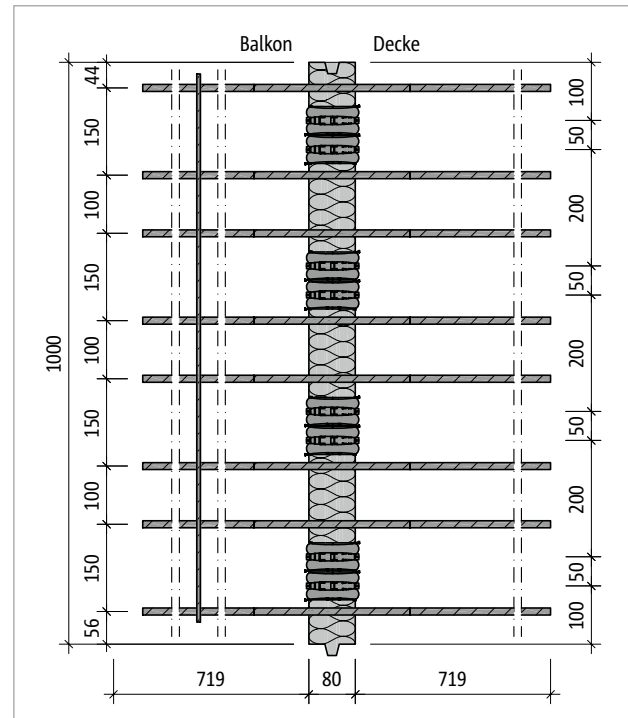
Schöck Isokorb® T Typ QL-V6: Produktgrundriss
